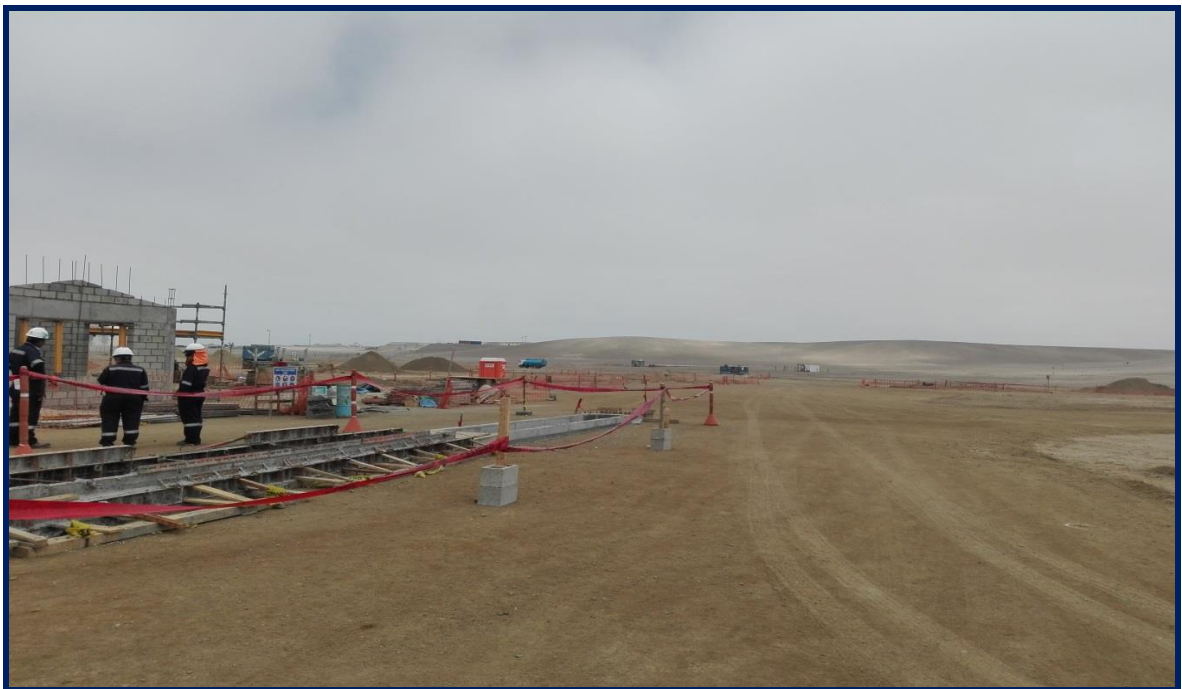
Vista del inicio del acceso vial de camiones cisternas hacia la bahía de carga
